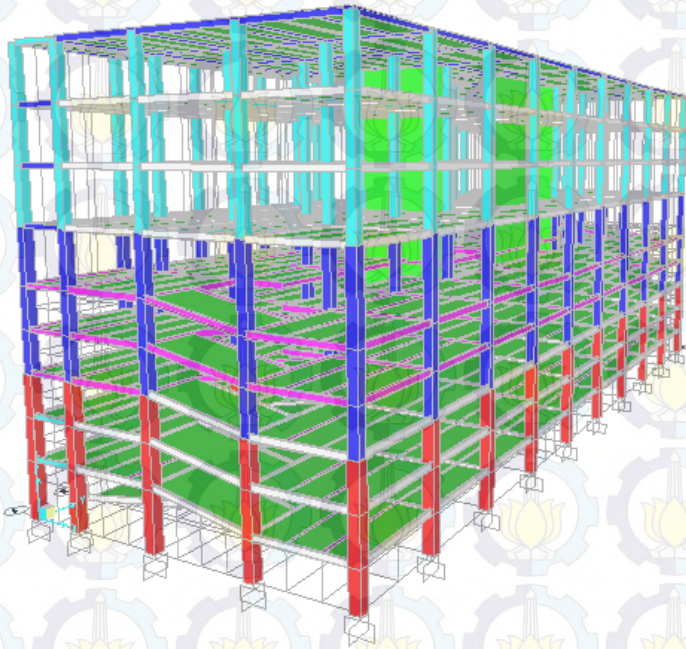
Denah Struktur Modifikasi Gedung Parkir dan Kantor PT.Pelindo II
